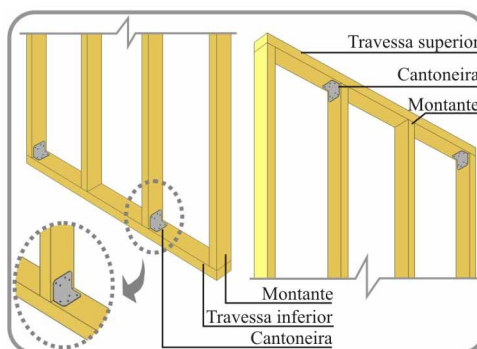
Reforço da ligação entre montante e travessa com cantoneiras metálicas
